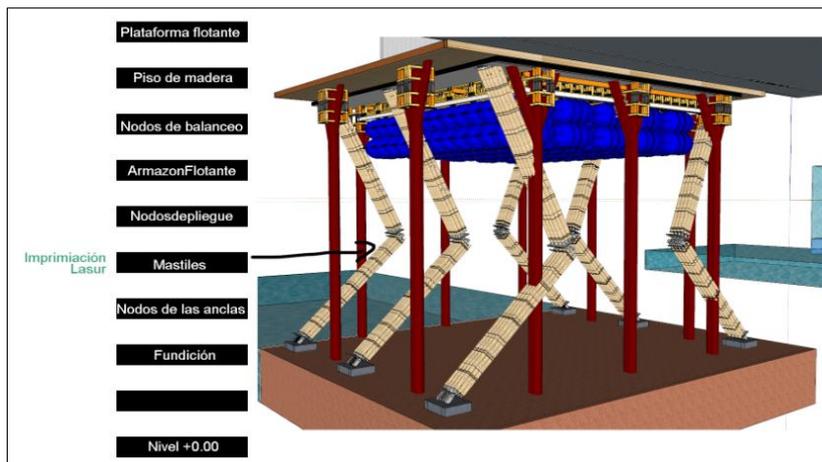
Elementos donde será pintado con imprimacionlasur vivienda 1 piso
